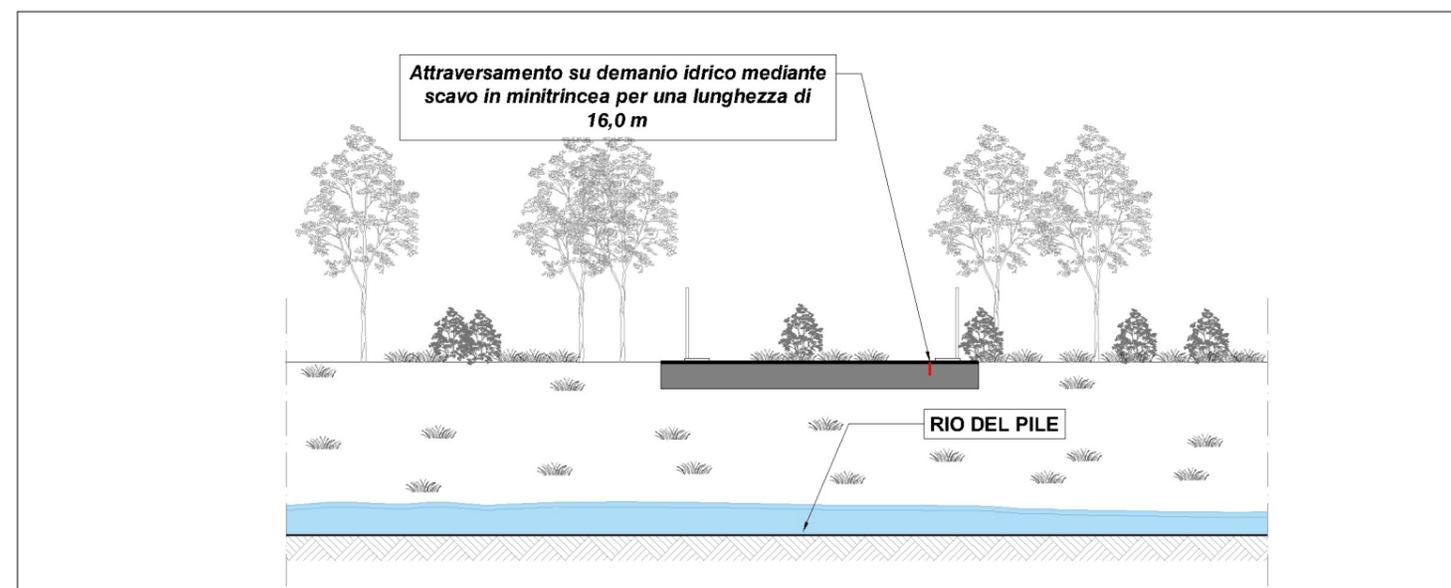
FOTO B - ATTRAVERSAMENTO E SIMULAZIONE INSTALLAZIONE
